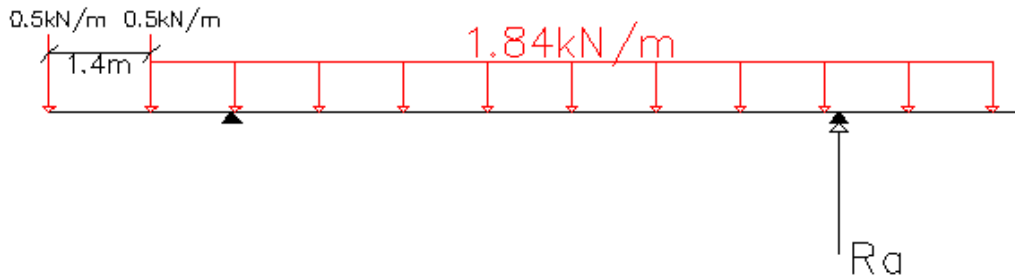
Aplicação das cargas (pavimento e guardas) na secção transversal
